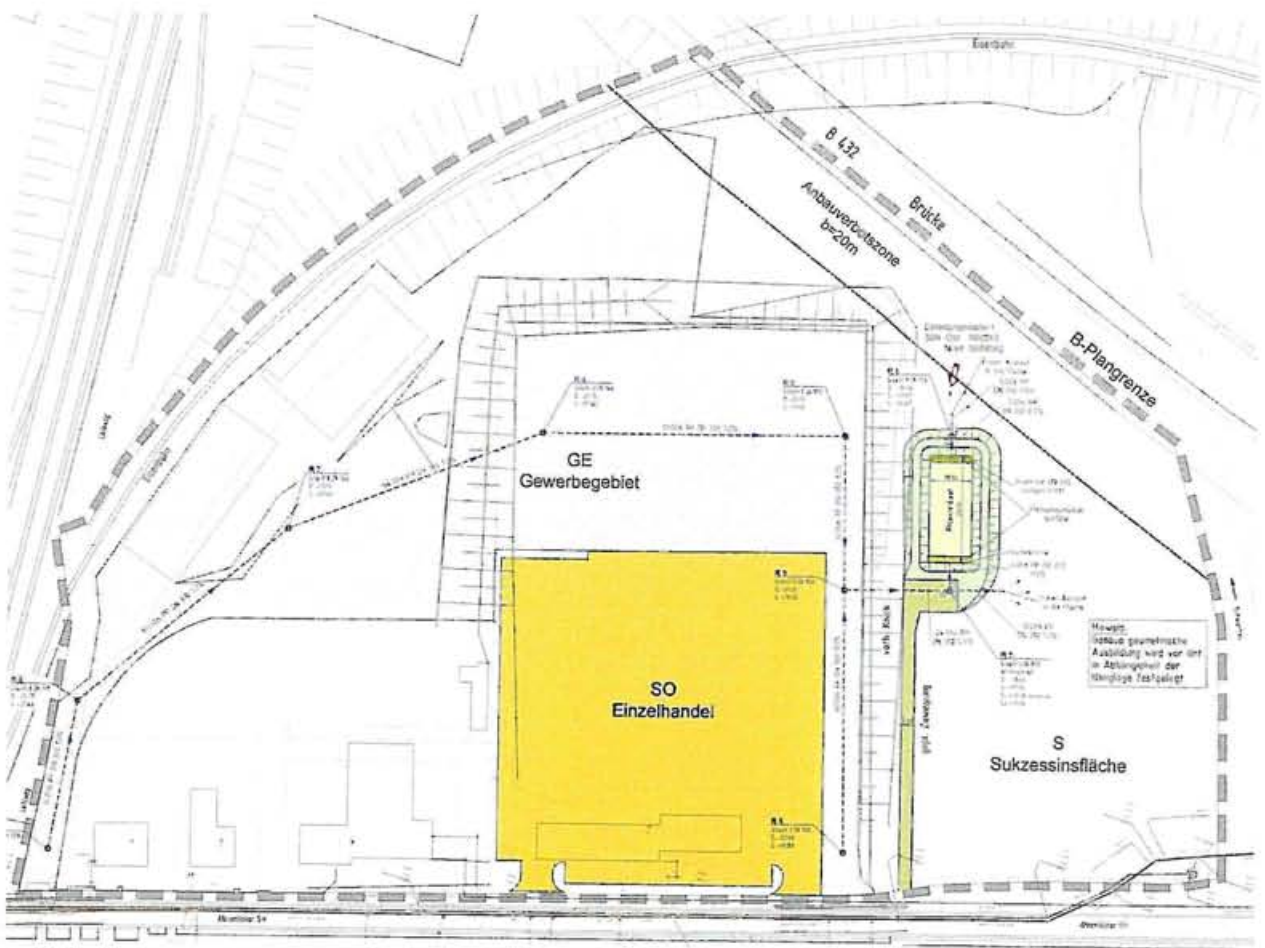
Lageplan zum Entwässerungskonzept der Gewerbliche Baufläche (G)
